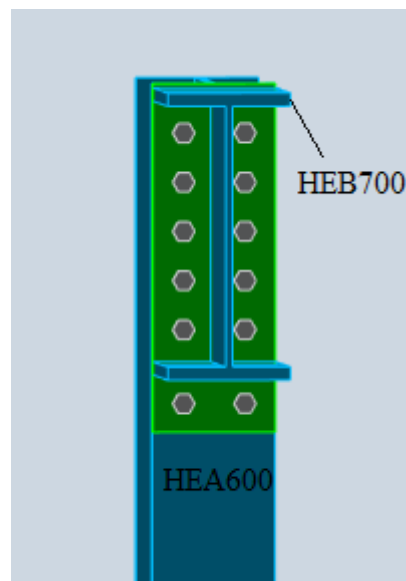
assemblage Poteau HEA600 – Poutre Principale HEB700
